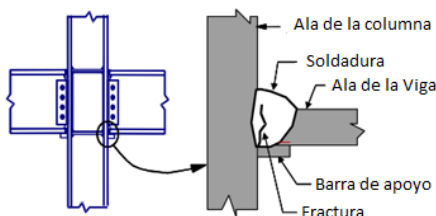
Zona común de fractura, conexión viga columna (tomado de FEMA 350)
